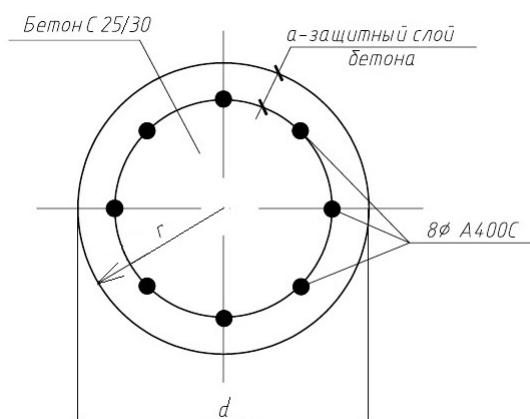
Поперечное сечение сваи с 8-ю арматурными стержнями
